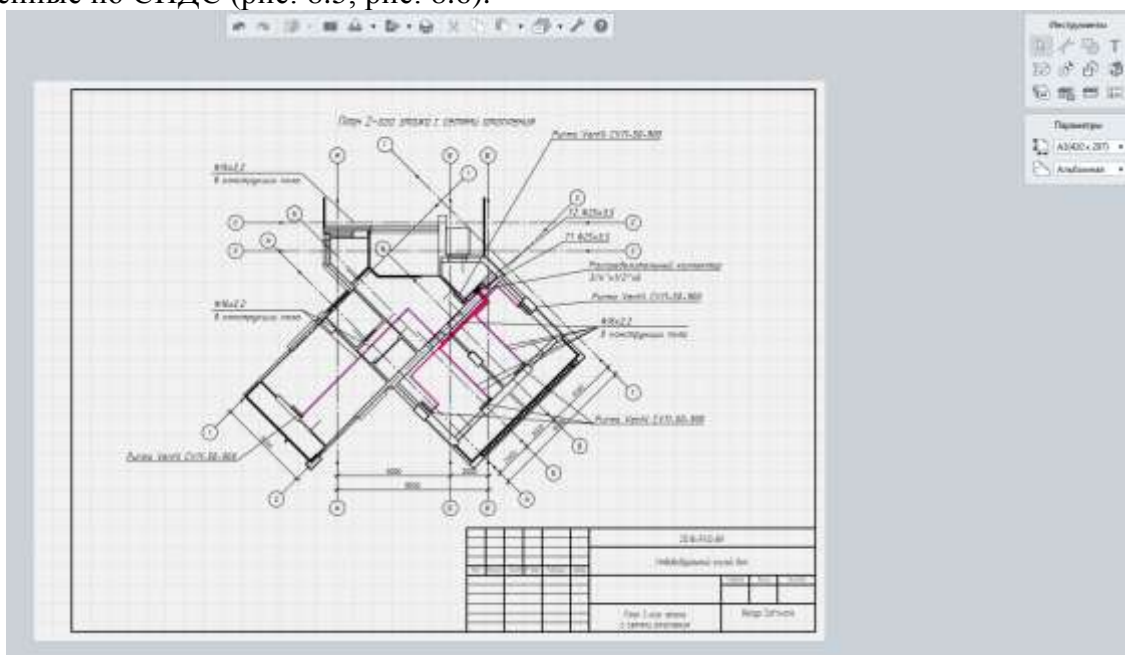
План 2-го этажа индивидуального жилого дома с сетями отопления
